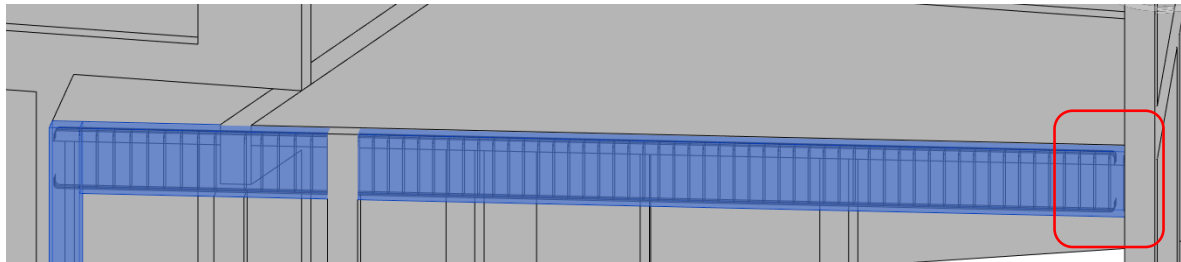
Falha no ajuste automática das armaduras longitudinais no apoio.
